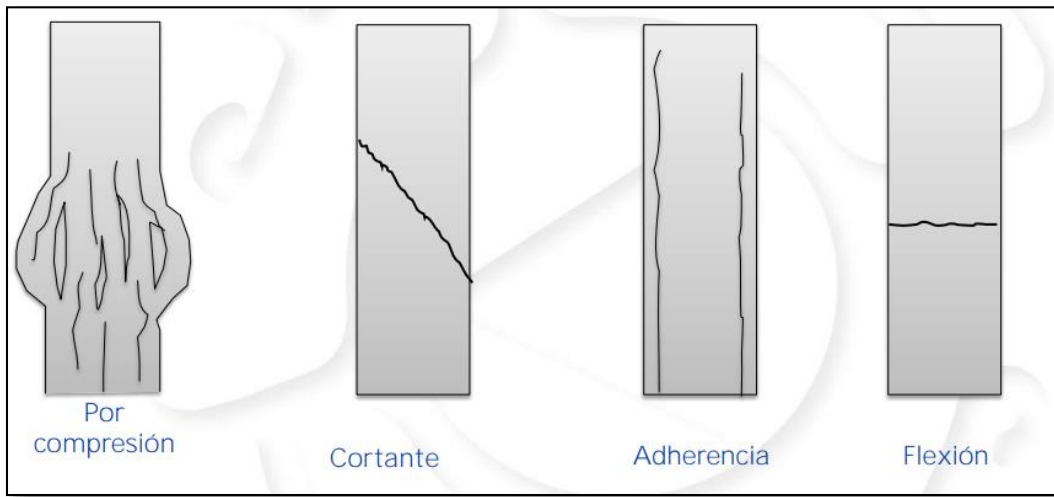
Fallas típicas estructurales en columnas de concreto armado
